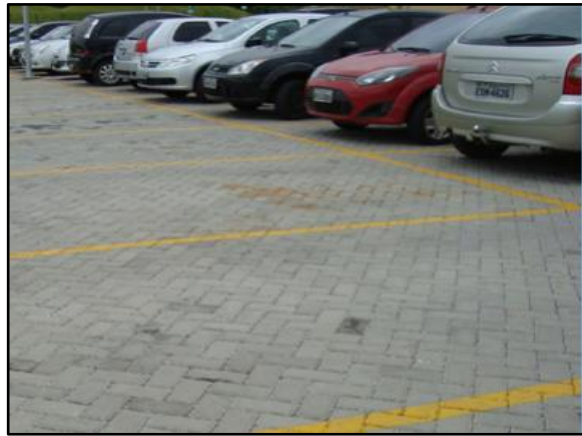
Pavimento poroso – piso intertravado instalado em passeio público
